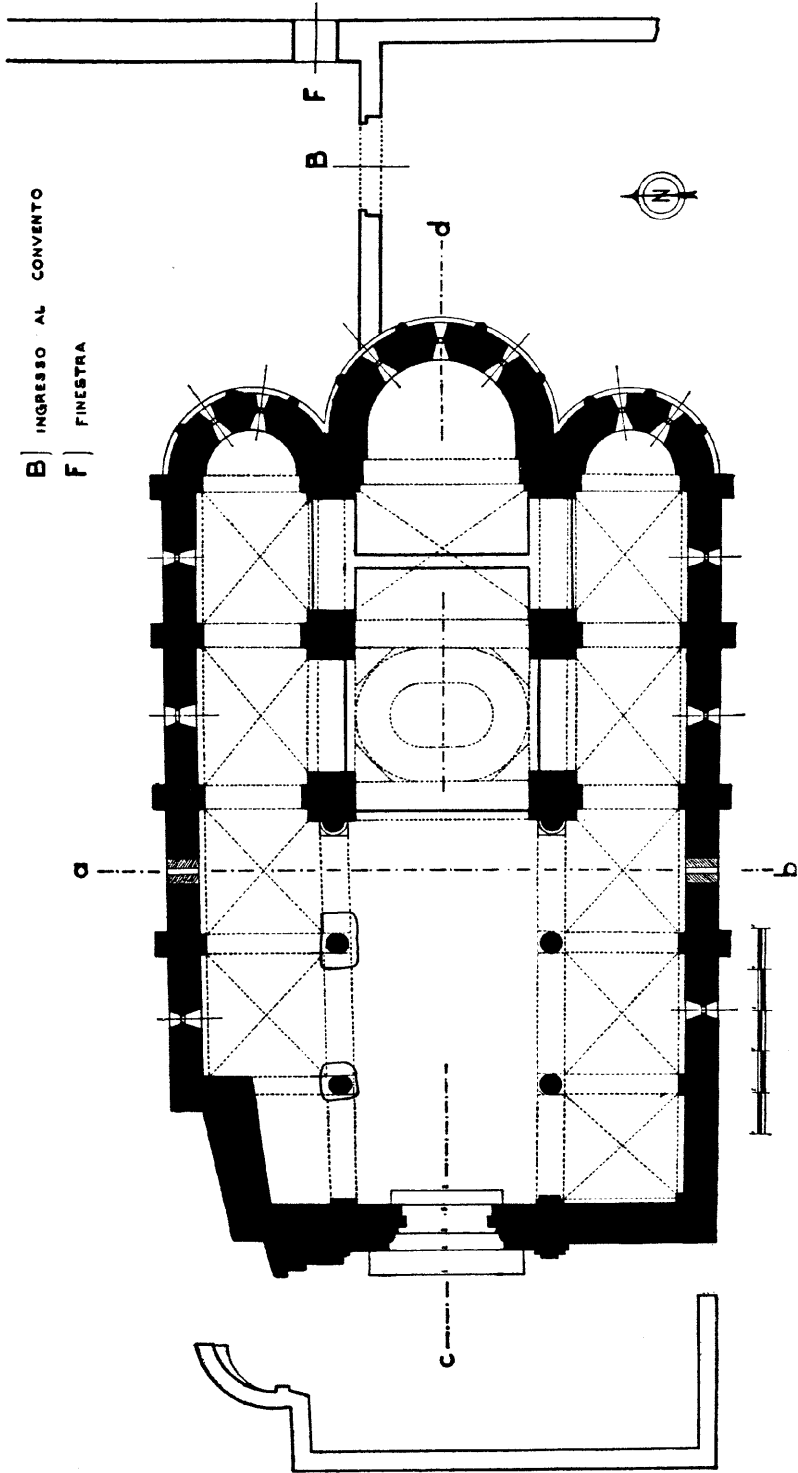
Fig. XI - CAPODIPONTE, S. SALVATORE: PIANTA
